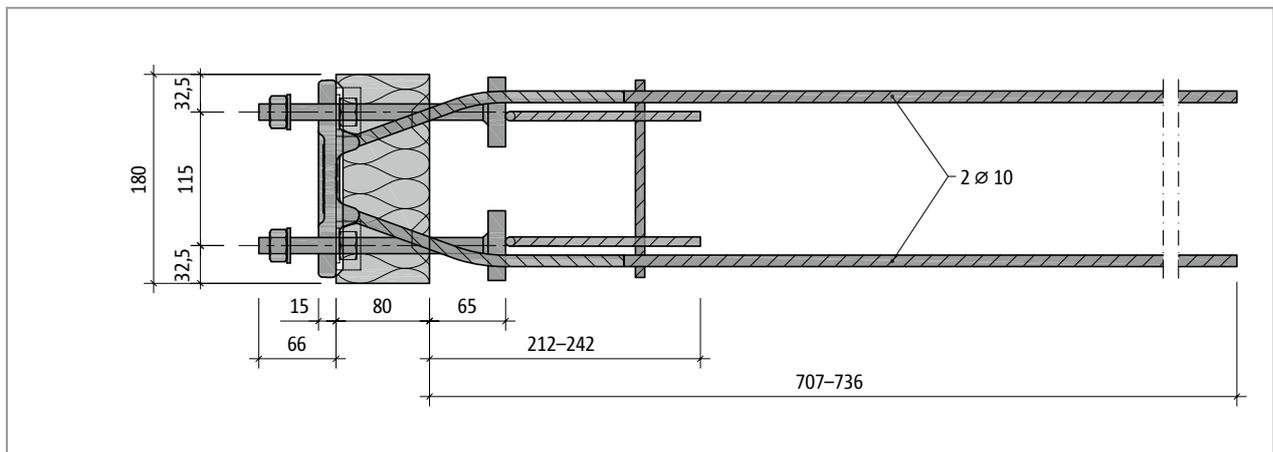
Schöck Isokorb® T tipo SQ-V2: Plano
